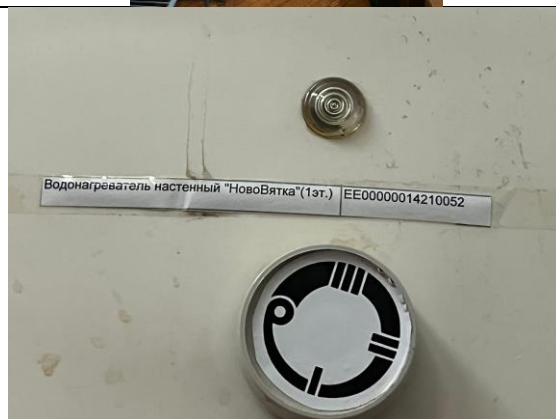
Помещение №45 (мойка) площадью 10,8 кв.м., расположенное на 1 этаже
